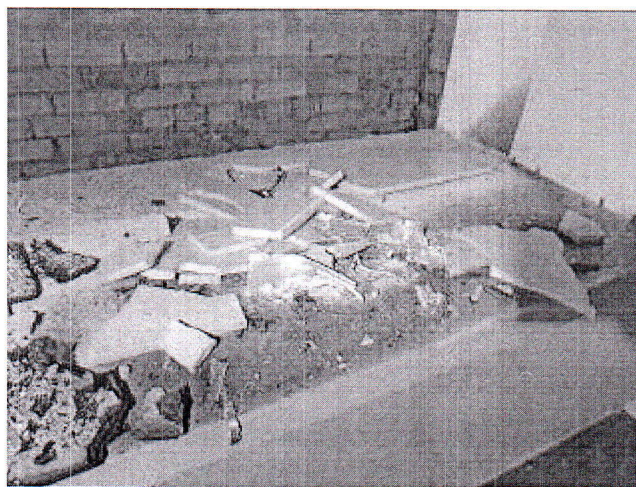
Б. Фрагмент образца фасада после испытания по ГОСТ 31251-2008.
